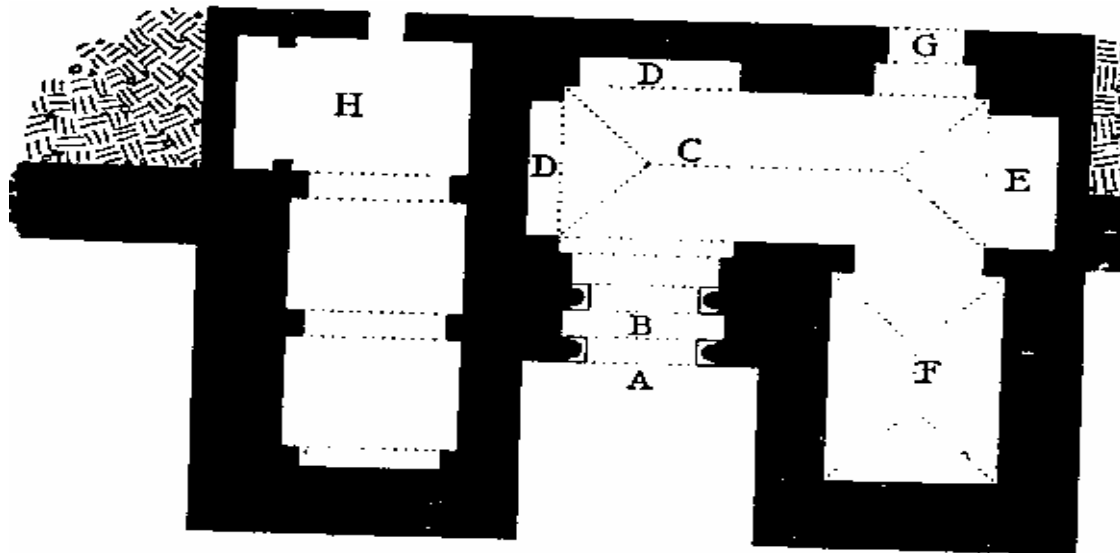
Planta de acceso de la Puerta de los Siete Suelos (Fdez. Puertas, The Alhambra).
